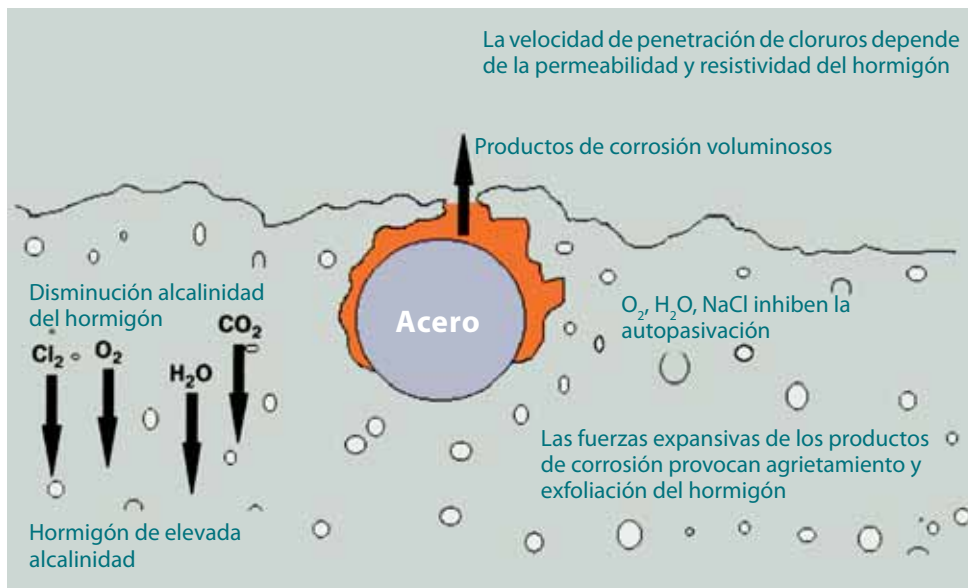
Corrosión de las armaduras de acero por efecto de la carbonatación y la penetración de cloruros.
